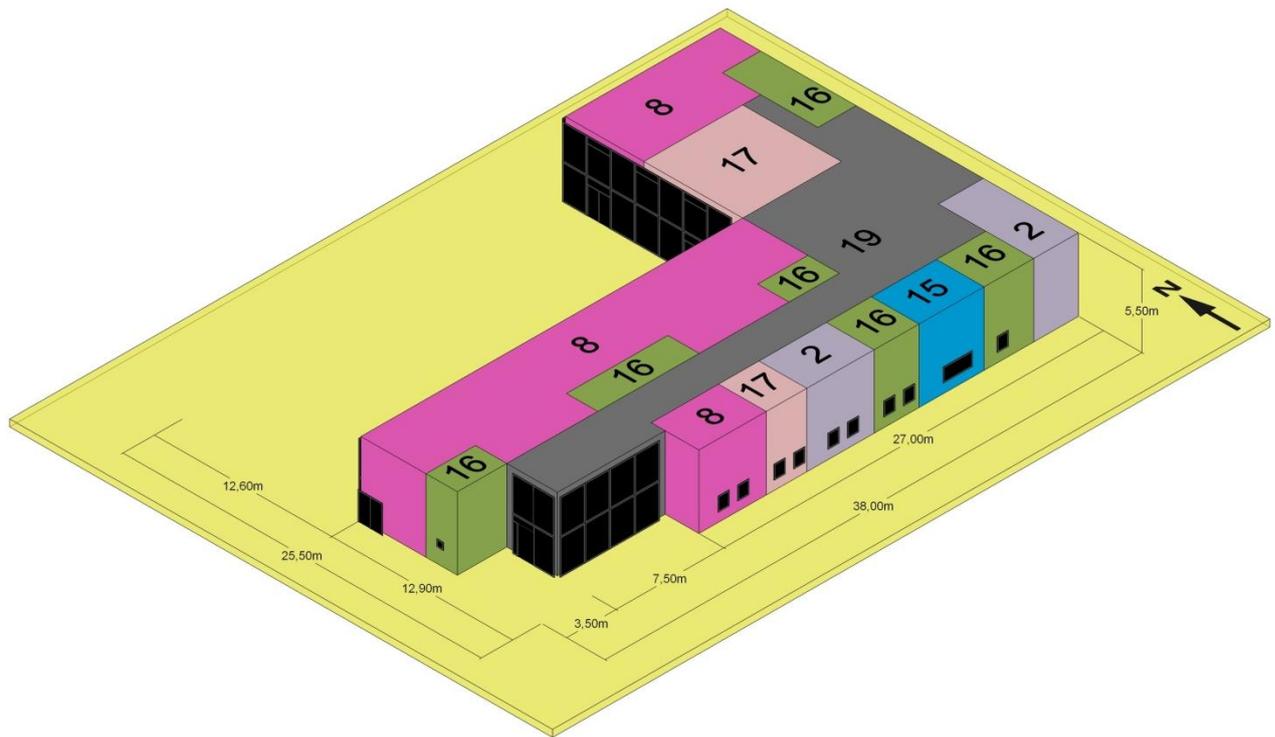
Kindergärten – Darstellung Zonen – Ansicht Süd-West
